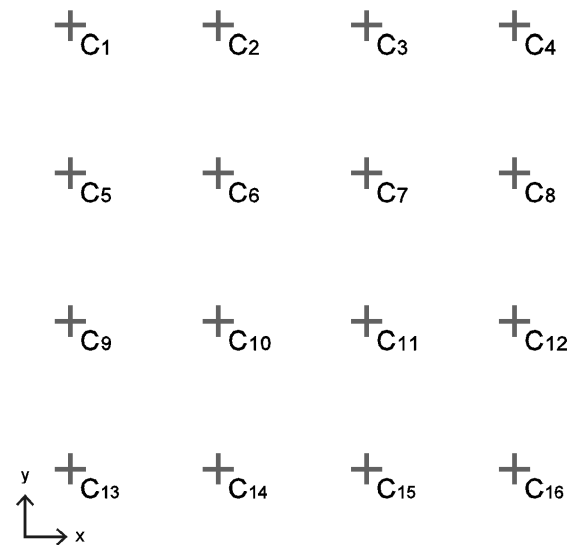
ˆDistribución en planta de los apoyos de las columnas de planta baja
